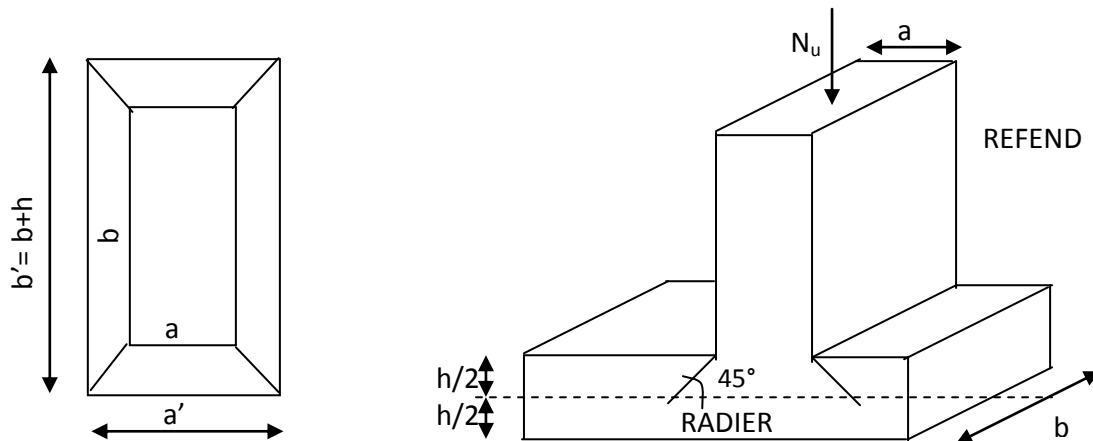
Périmètre utile des voiles et des poteaux.
